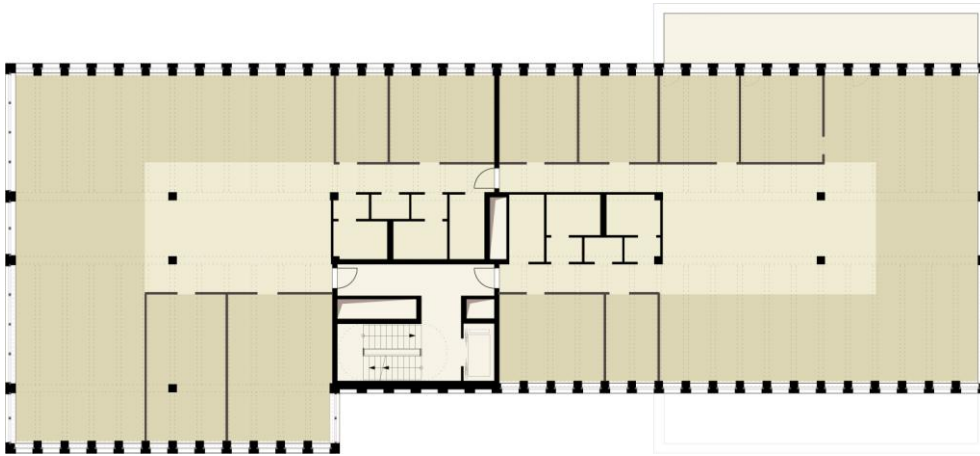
SuperBioMarkt, Grundriss Obergeschoss
